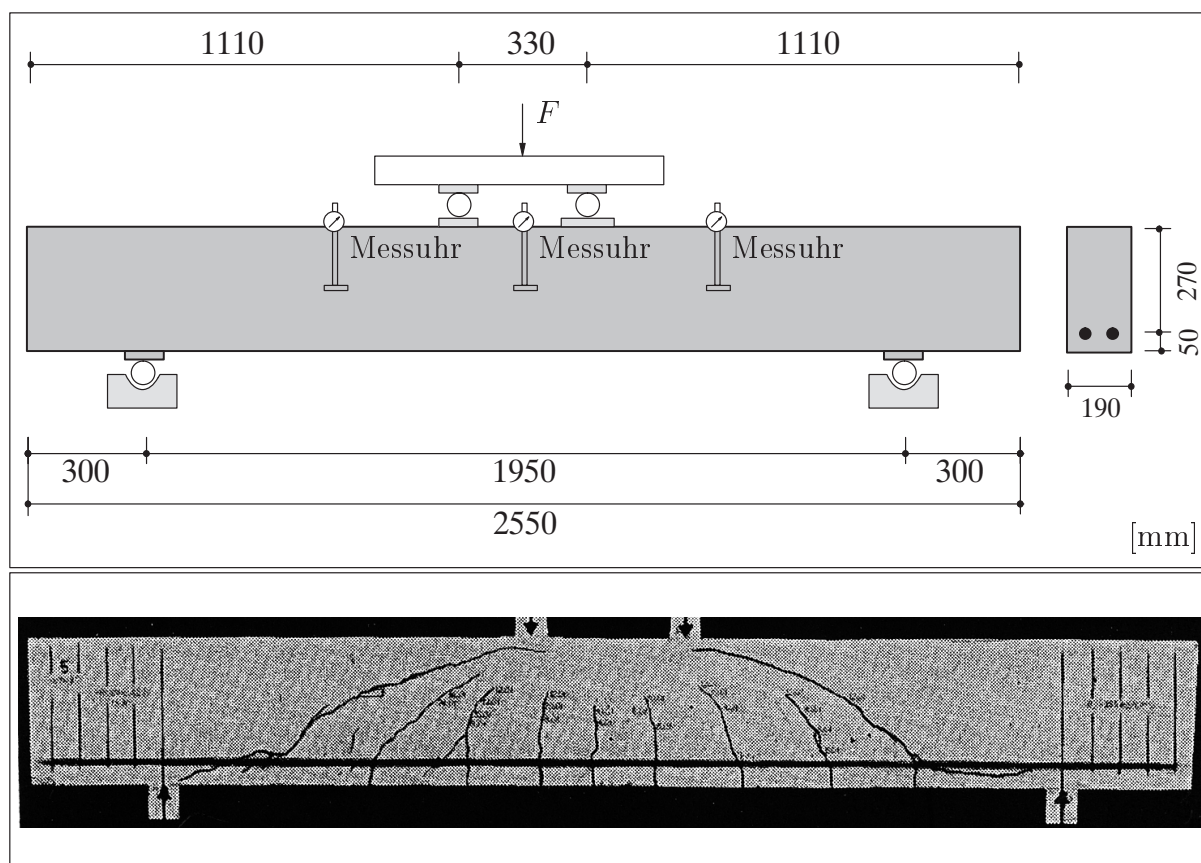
Oben: Geometrie und Belastung des Stahlbetonbalkens. Unten: Stahlbetonbalken mit experimentellem Rissmuster [99]
